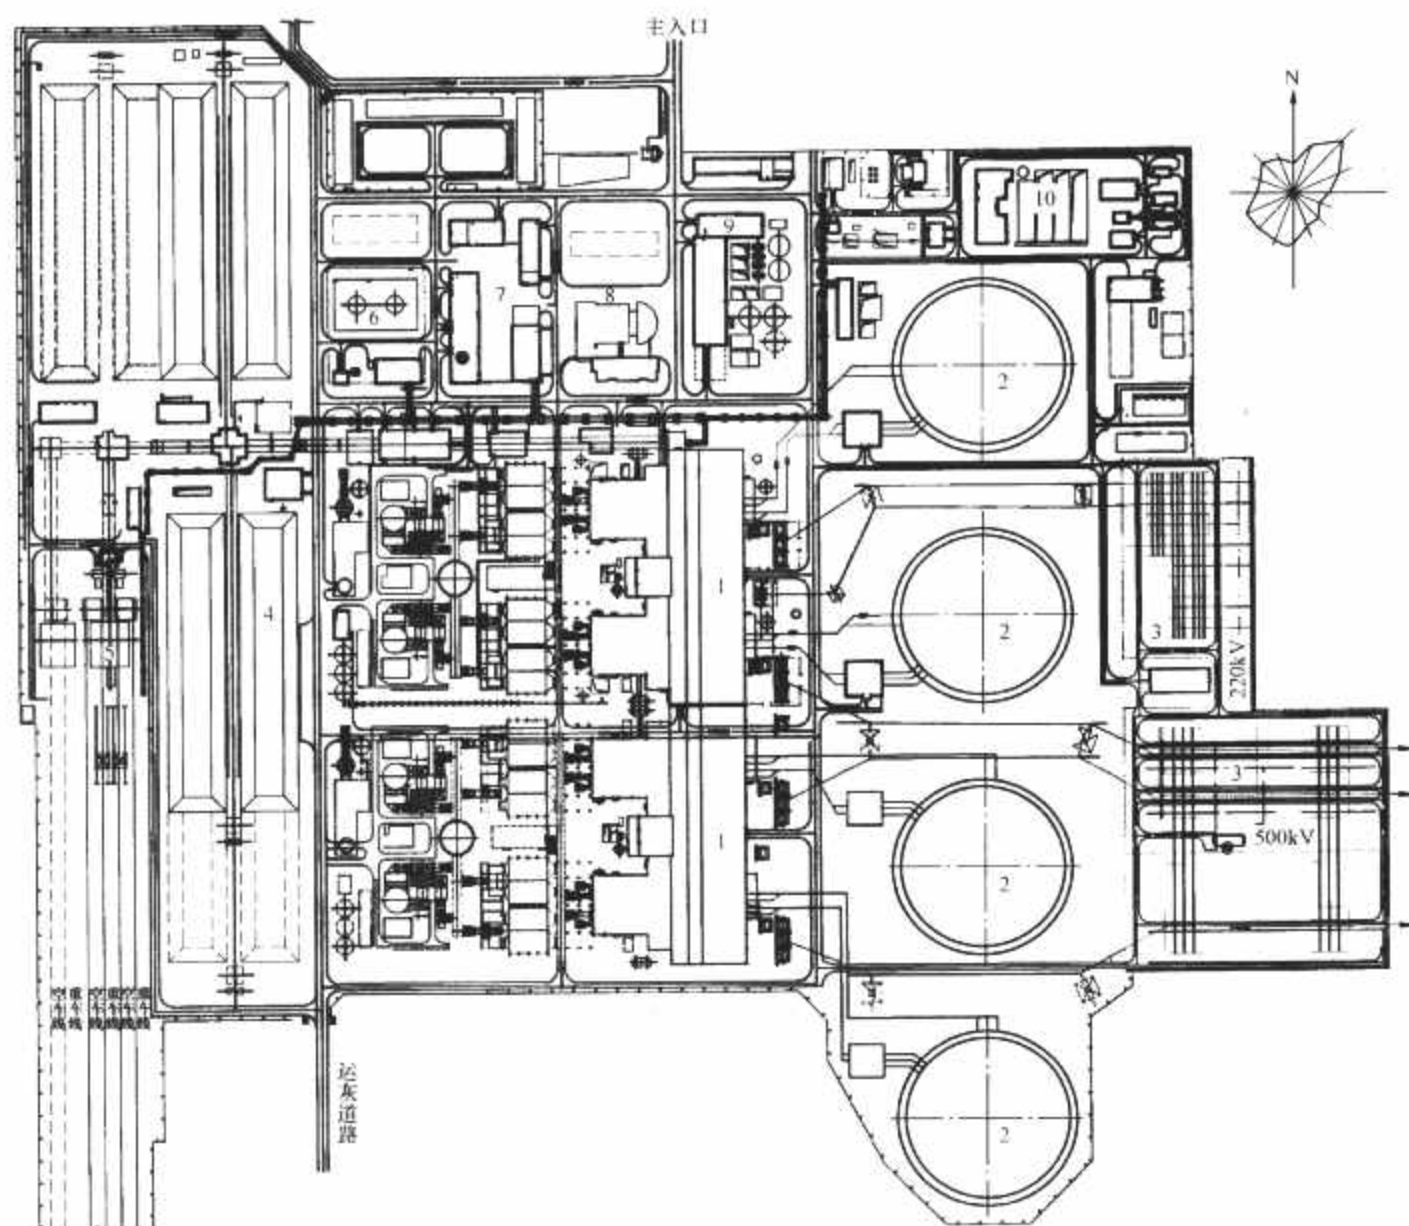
冷却塔布置在主厂房 A 列外、配电装置之间的电厂总平面布置图
